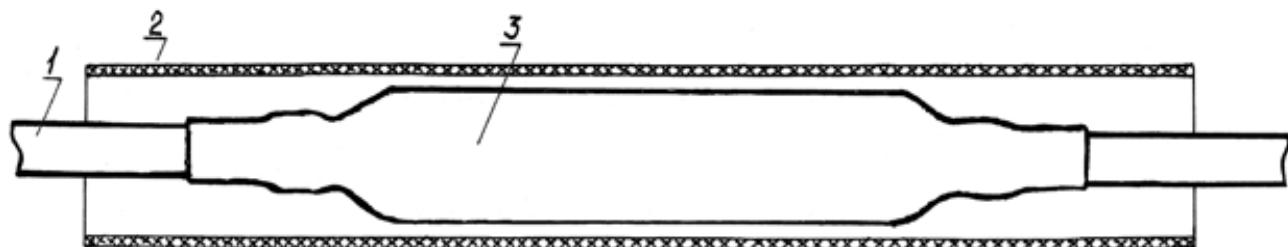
Усадка наружной трубы ТУТ. Наружная трубка ТУТ должна перекрывать внутреннюю с каждой стороны муфты не менее чем на 70 мм: 1 – кабель с покровом типа «Шп»; 2 – наружная трубка ТУТ; 3 – усаженная внутренняя трубка ТУТ.
